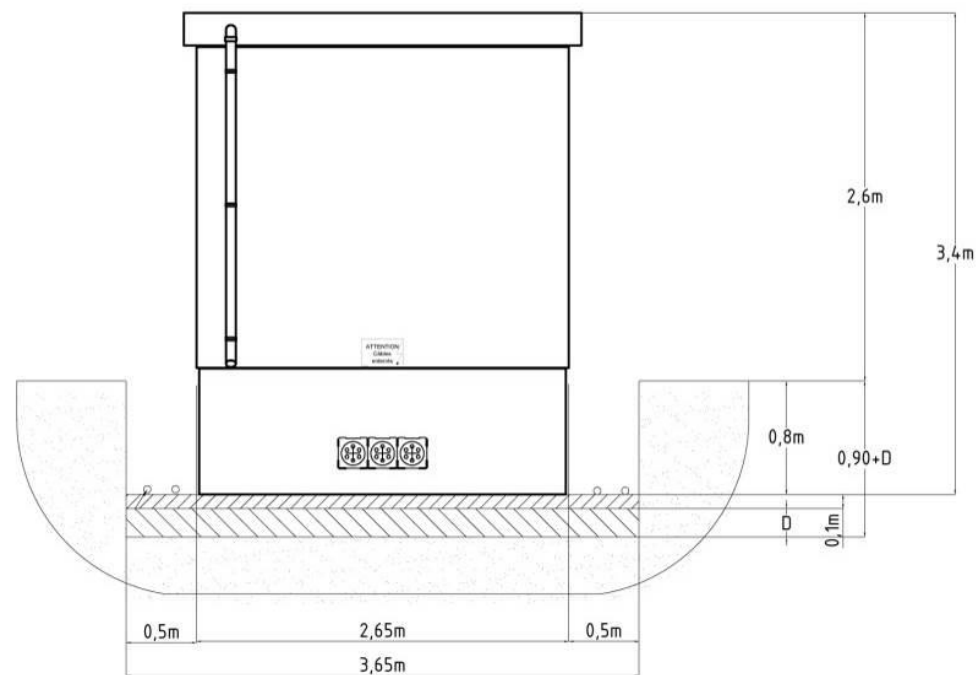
Plan de façade d'un poste de livraison (vue de profil)
